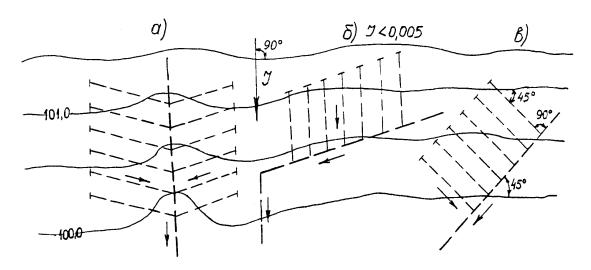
Схемы расположения дренажа в плане а) – поперечная; б) – продольная; в) – комбинированная
